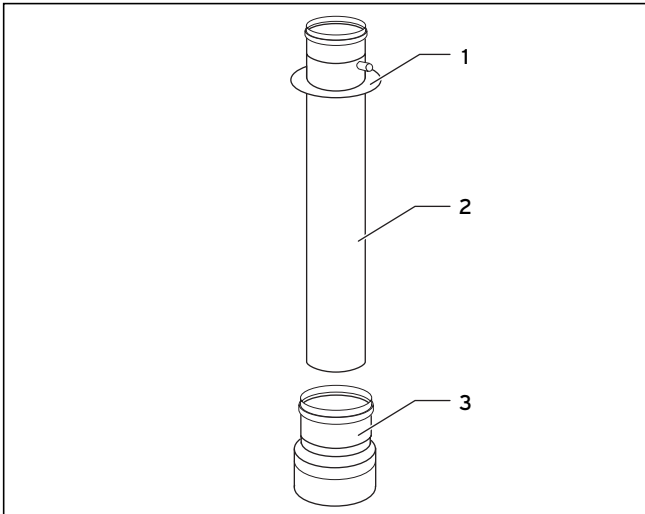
Монтаж подсоединения газоотвода (арт. № 303 970)
